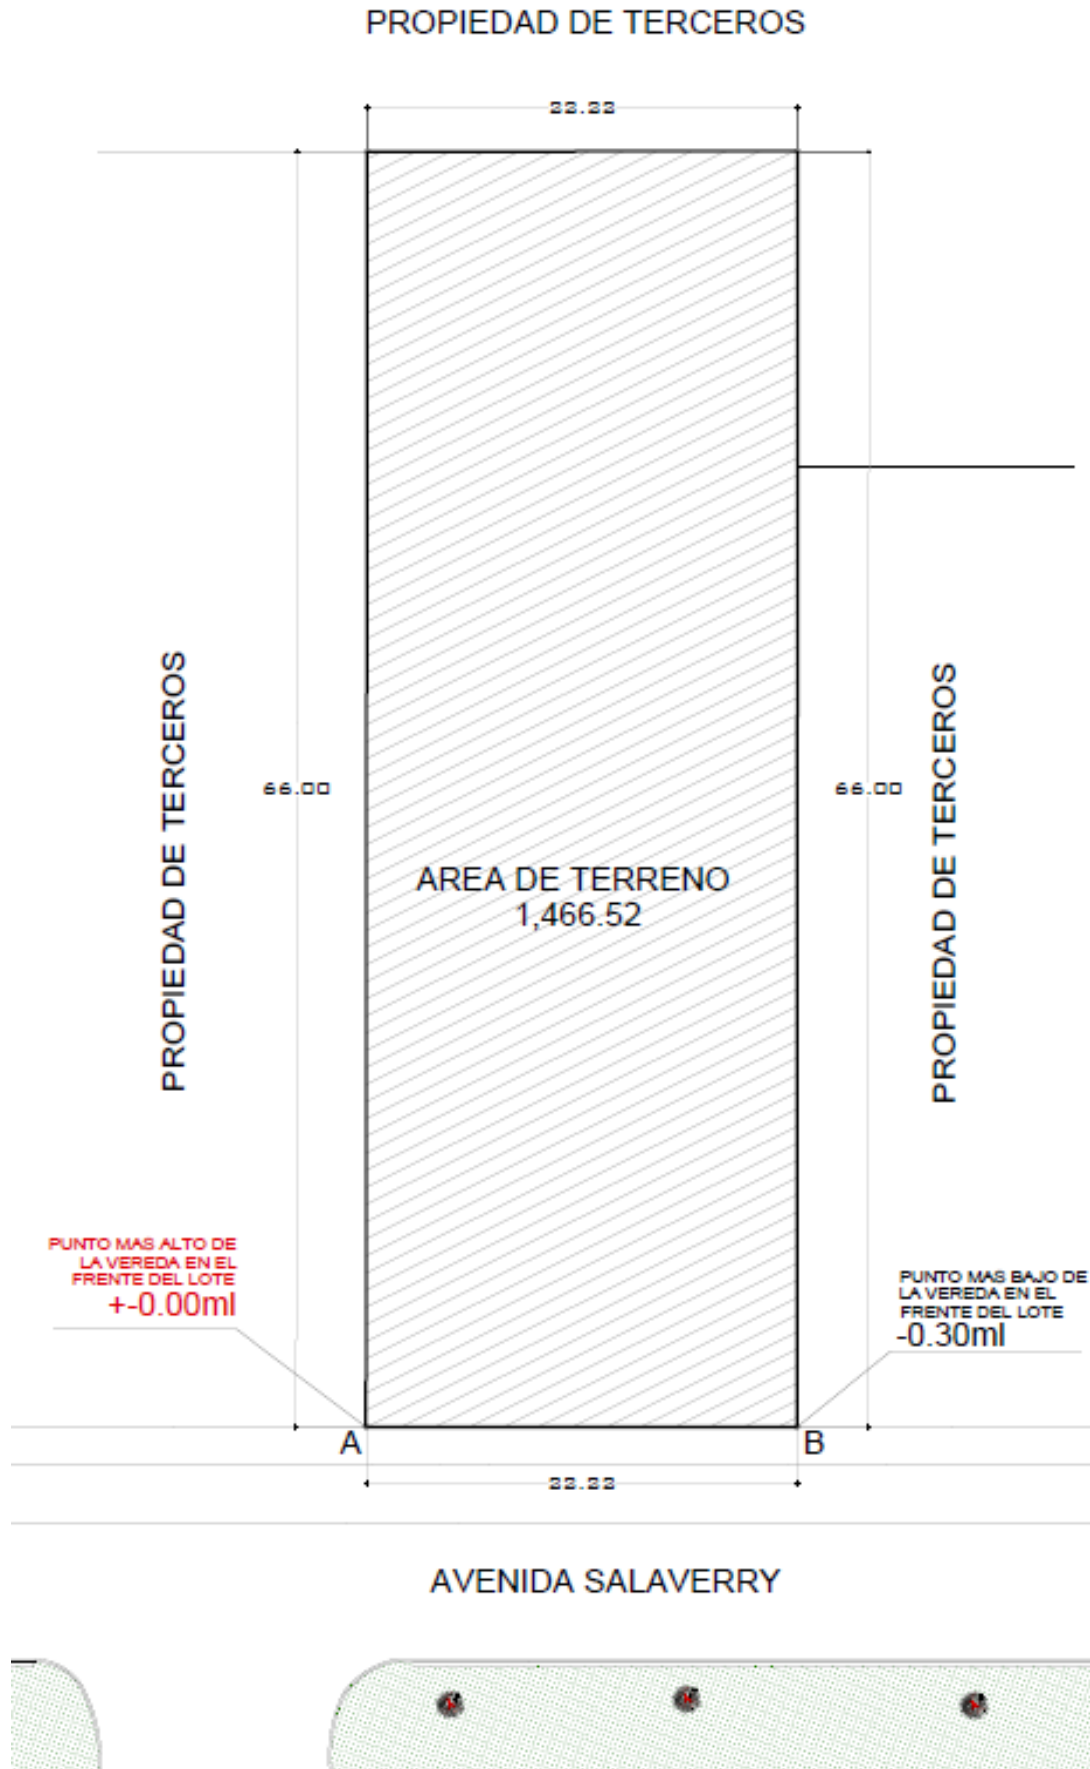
Plano de ubicación del terreno con las alturas de vereda en el frente del terreno.
